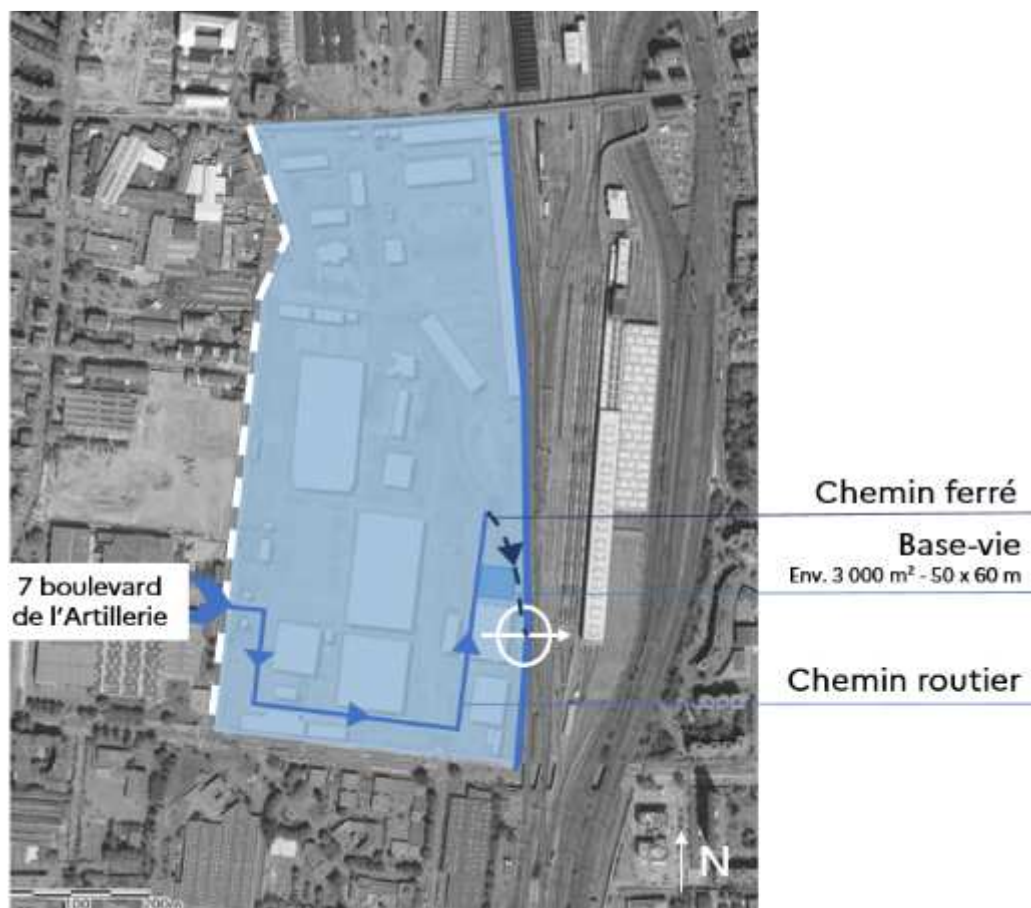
Plan d'accès au chantier via le 7<sup>ème</sup> RMT
